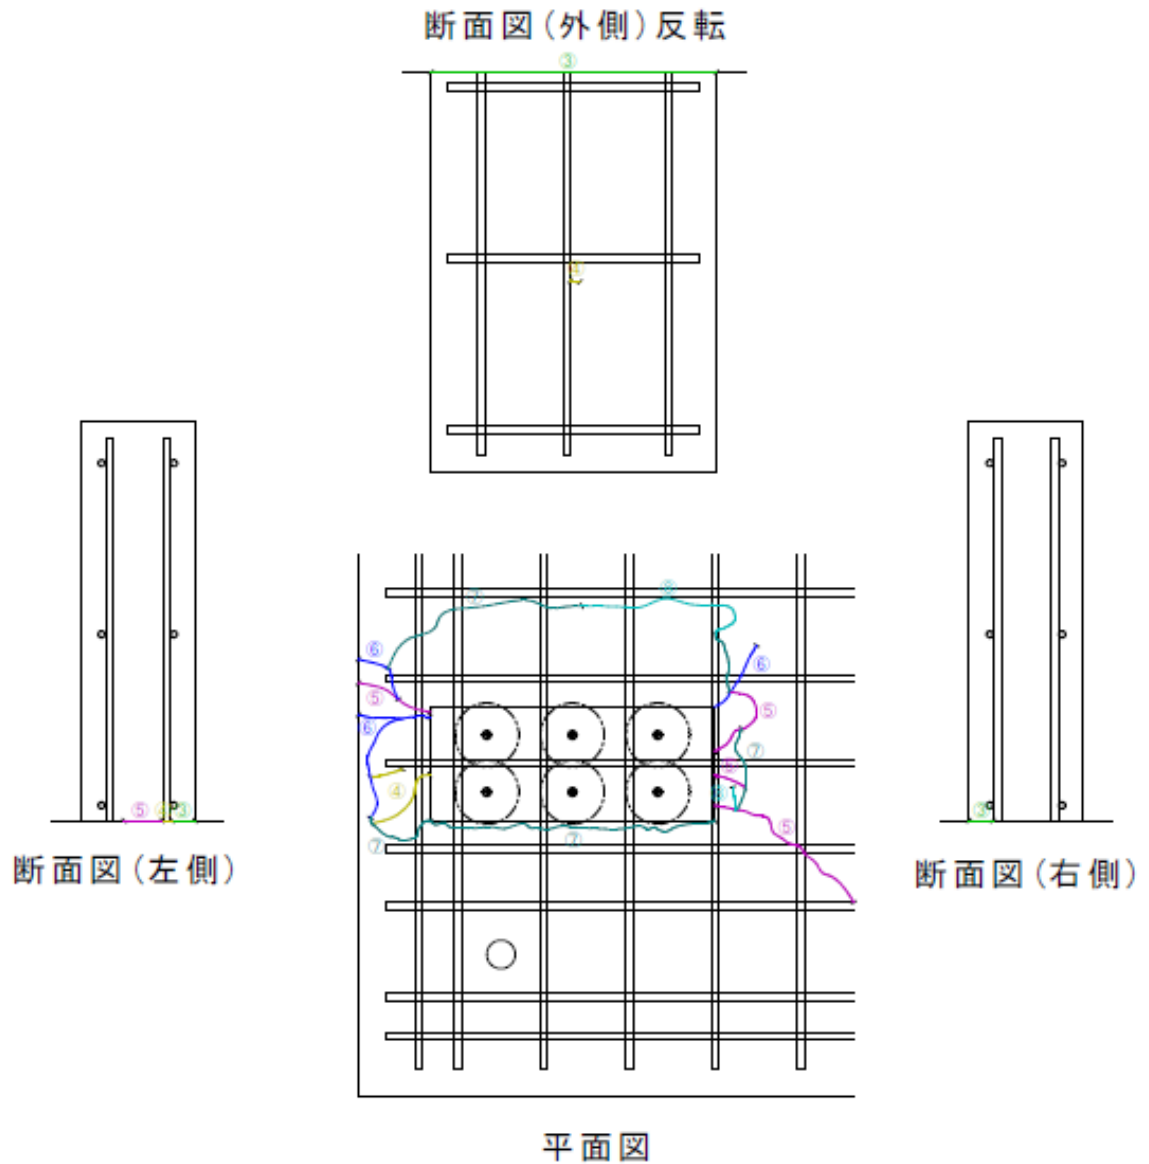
ひび割れ図および最終破壊状況写真 (No.5L)
